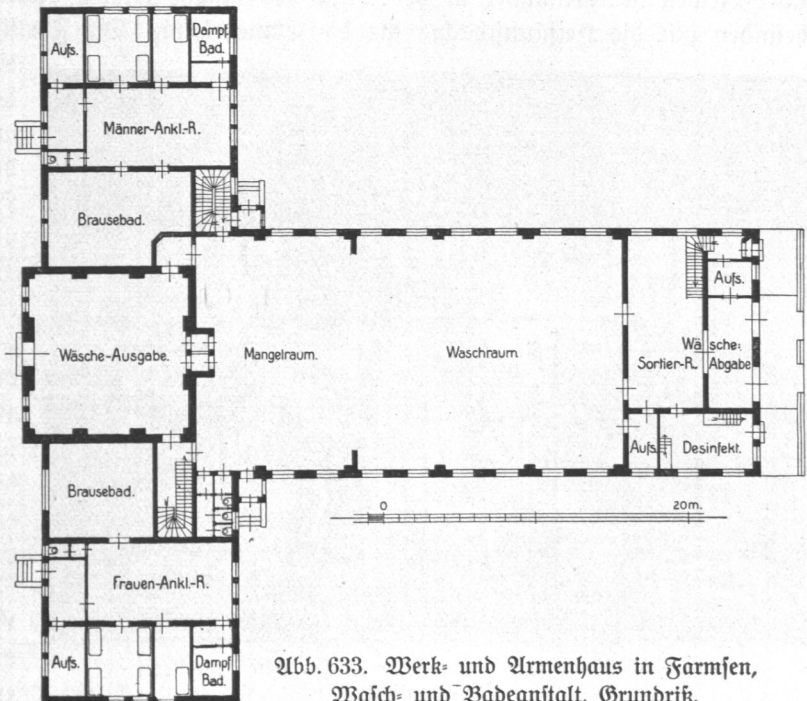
Werk- und Armenhaus in Farmsen, Wasch- und Badeanstalt, Grundriß.
